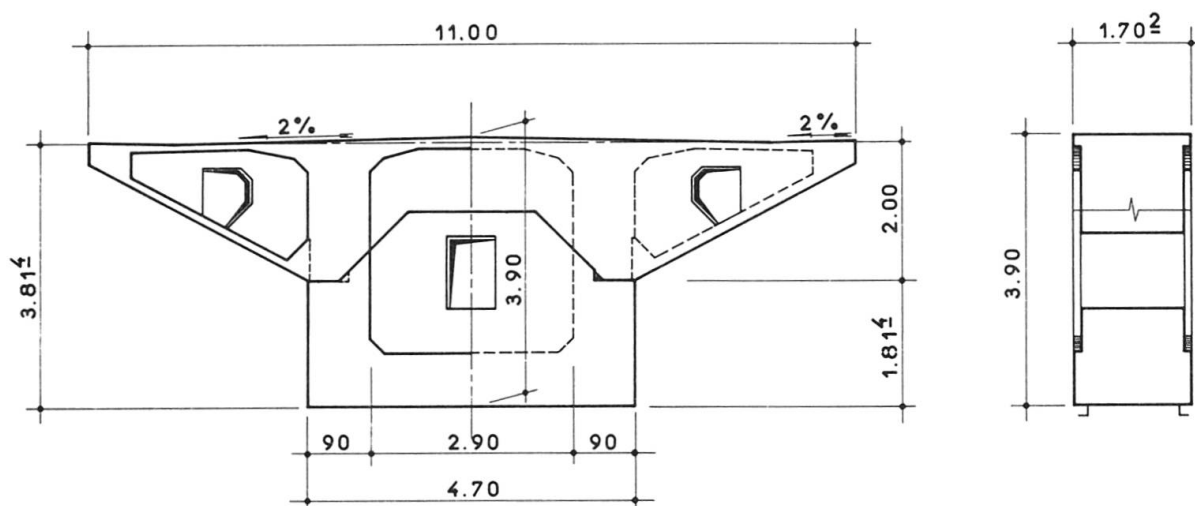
Voussoir sur pile de Marne-la-Vallée
